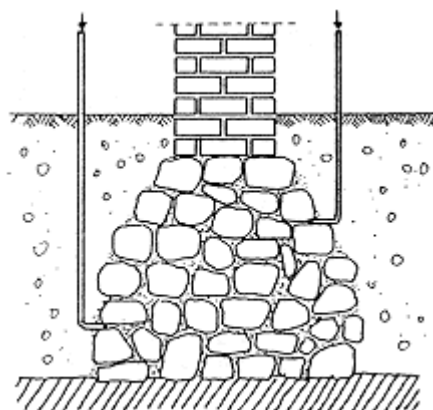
Injeção de caldas de cimento em sapatas de alvenaria de pedra [12]
